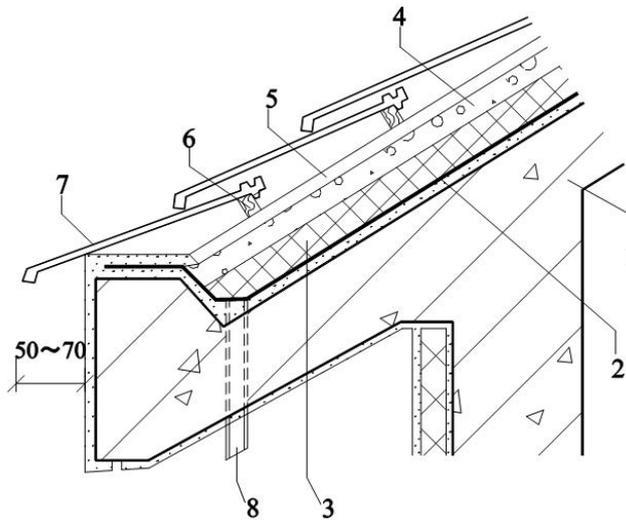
烧结瓦、混凝土瓦屋面檐口
